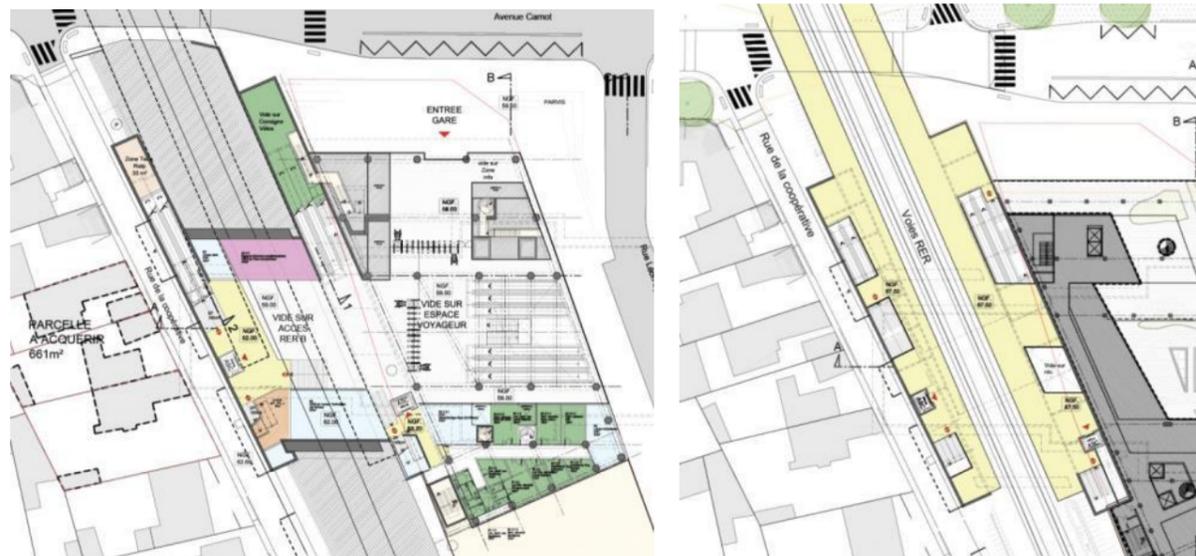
Gare d'Arcueil Cachan - Plan niveau N+1
